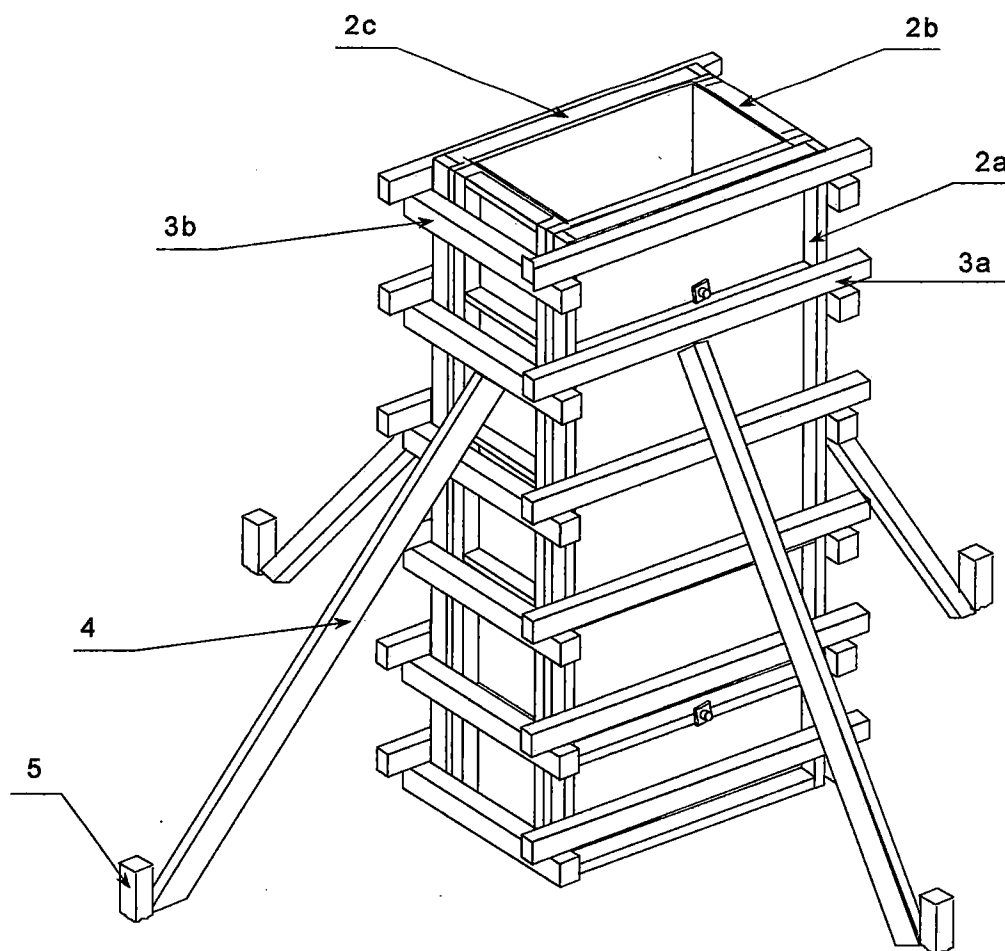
Encofrado de columna de concreto expuesto.
